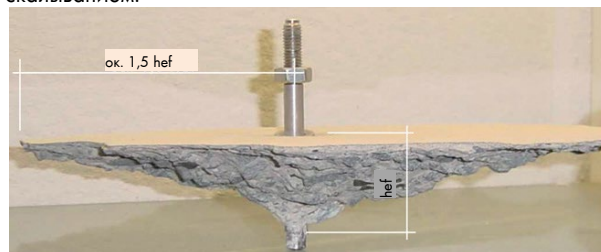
Разрушение бетона при испытании методом отрыва со скалыванием анкера W-FAZ
